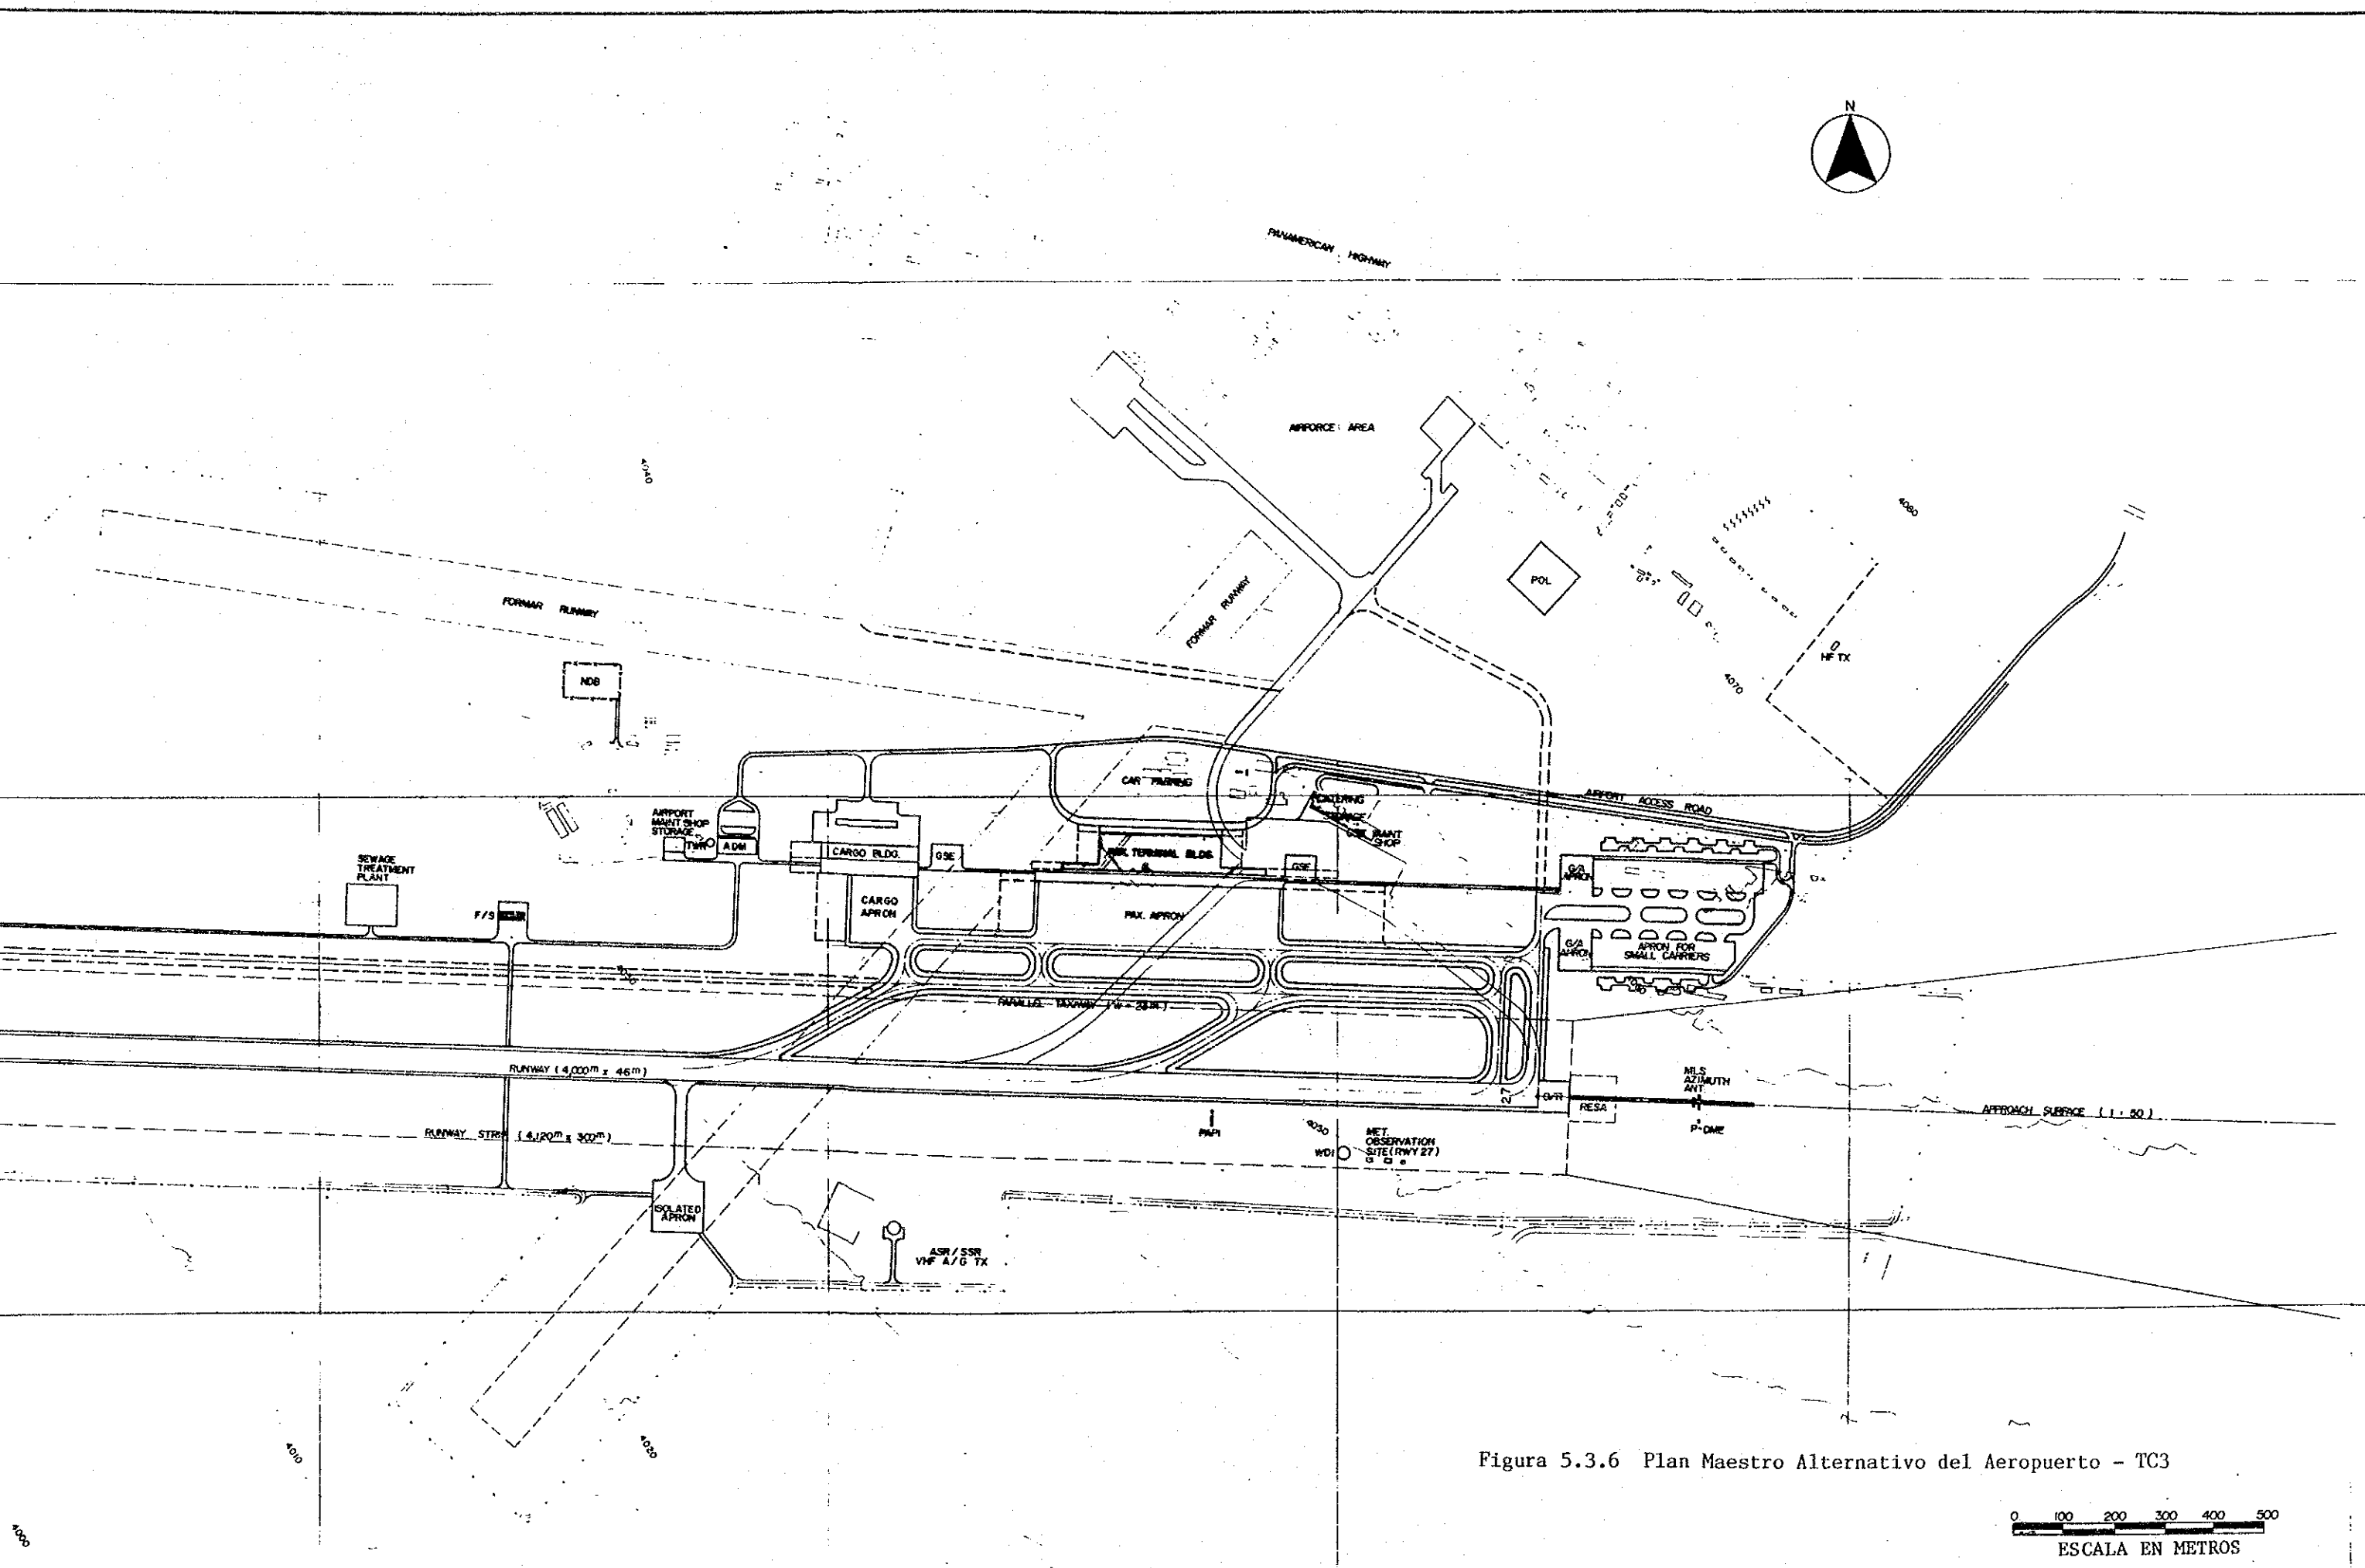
Plan Maestro Alternativo del Aeropuerto - TC3
